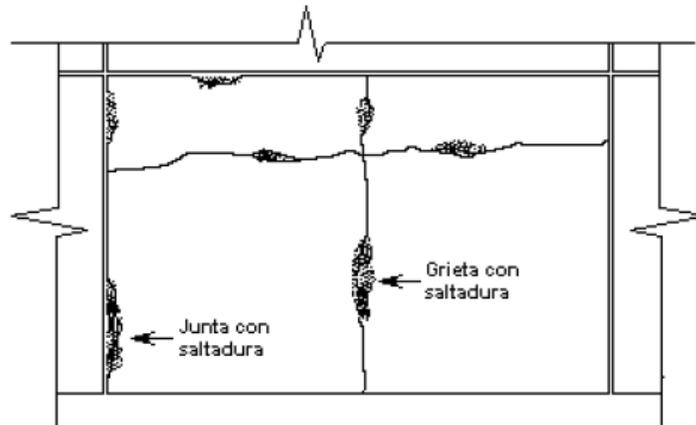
Pavimento de hormigón afectado por grietas con saltaduras.
